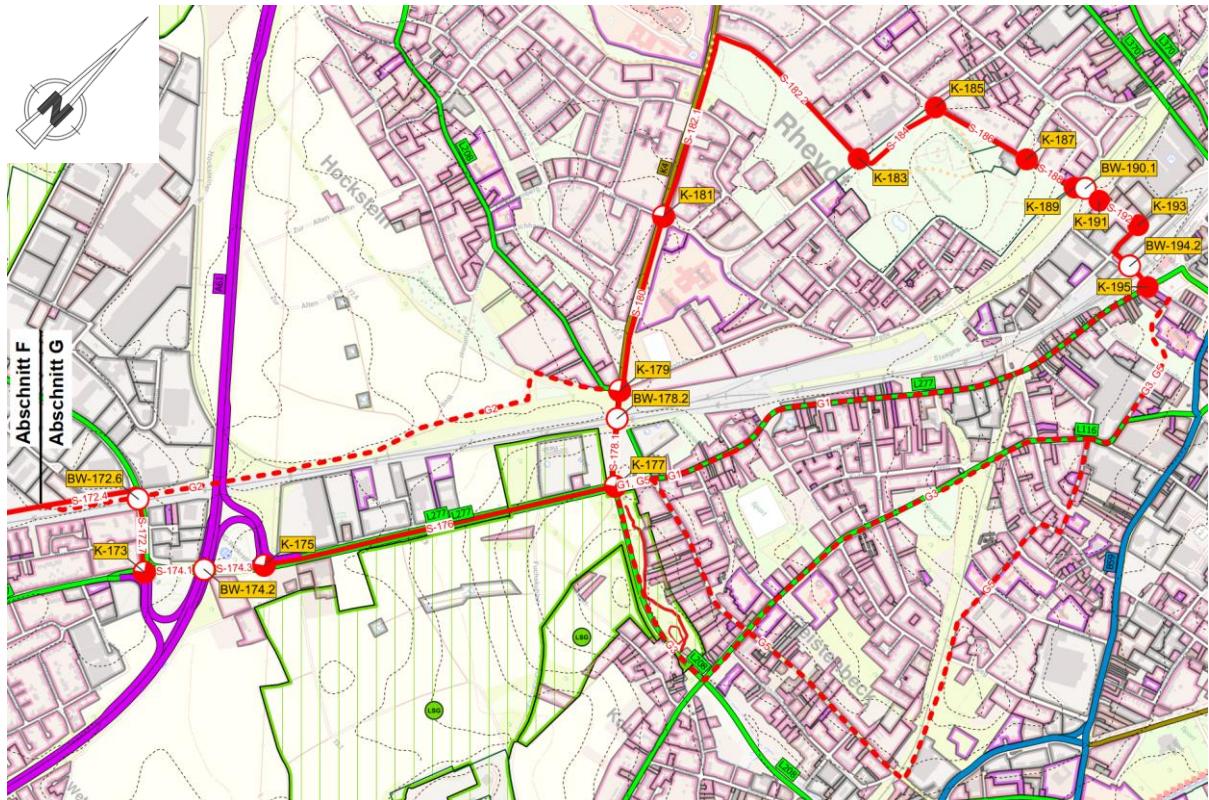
Auszug (Bewertungsabschnitt G) aus dem Übersichtslageplan
